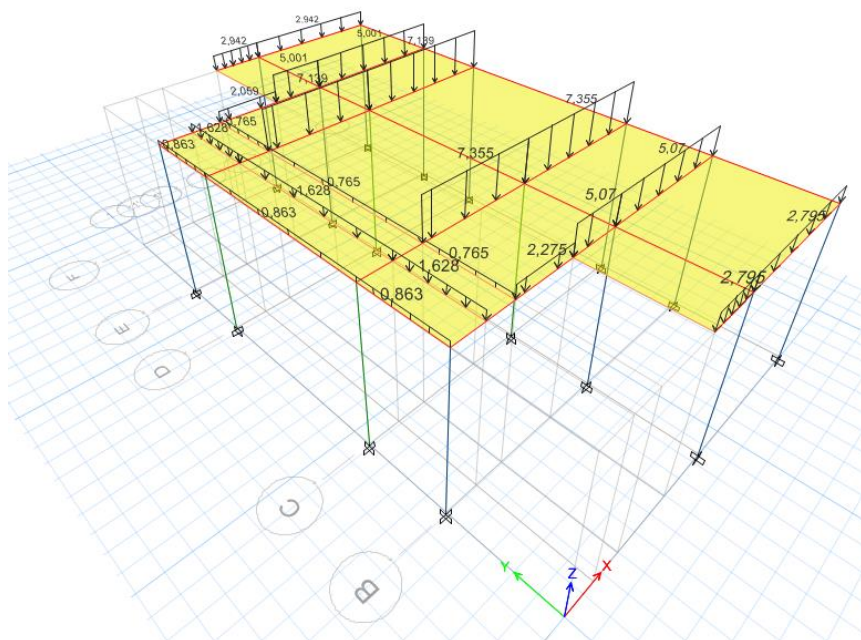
Cargas vivas sobre la cubierta (KN/m)
